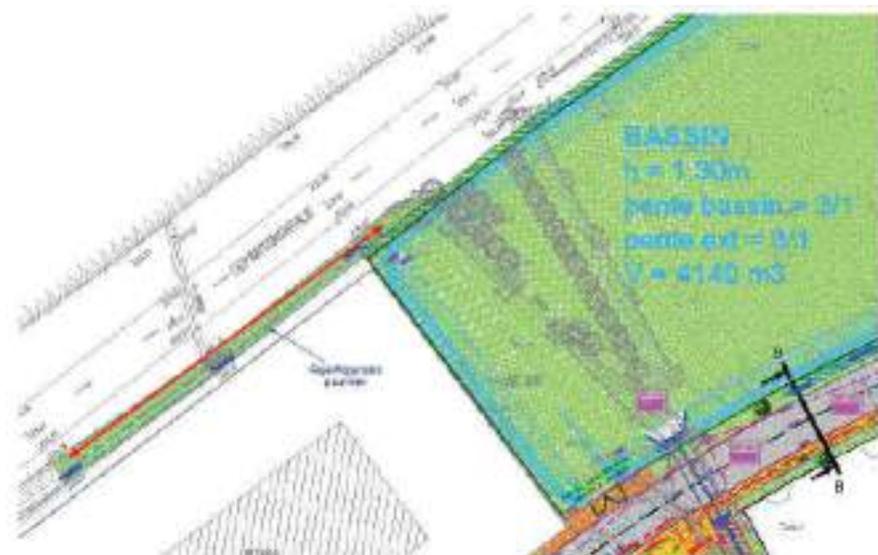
Vue en plan du bassin de rétention des eaux pluviales
